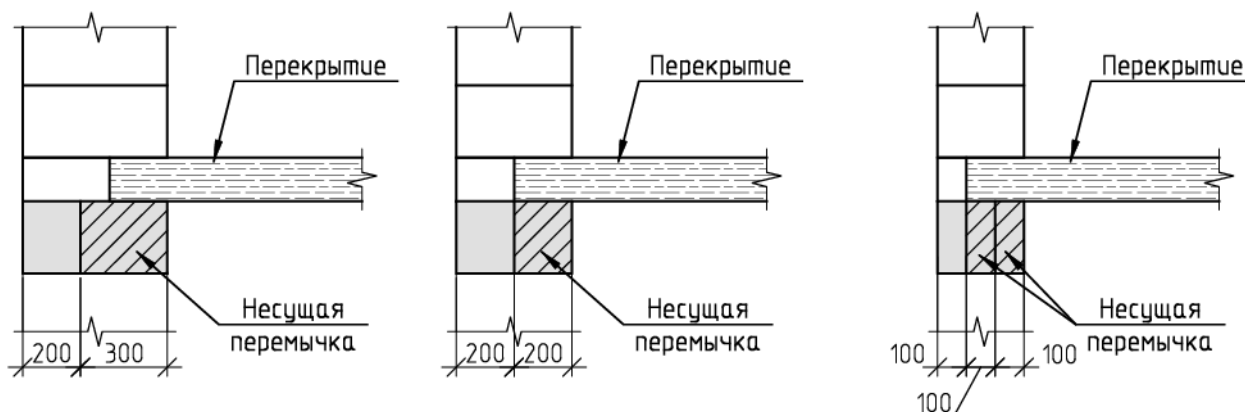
Разделение перемычек на несущие и ненесущие при опирании перекрытия непосредственно на перемычку
